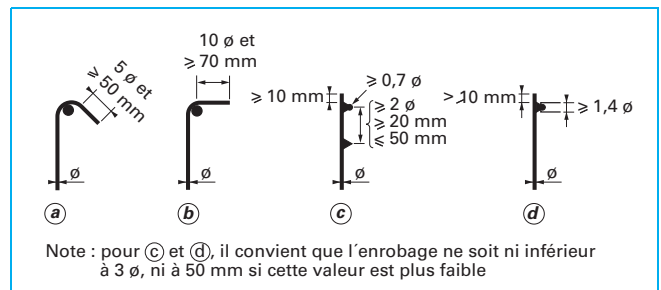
Ancrage des armatures transversales (figure 8.5 de l'EC2)
